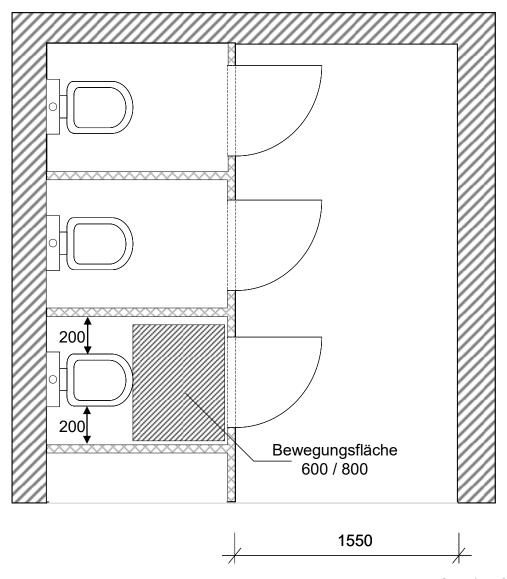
Einbündige Toilettenanlage, Türanschlag nach außen (Maße in mm)
